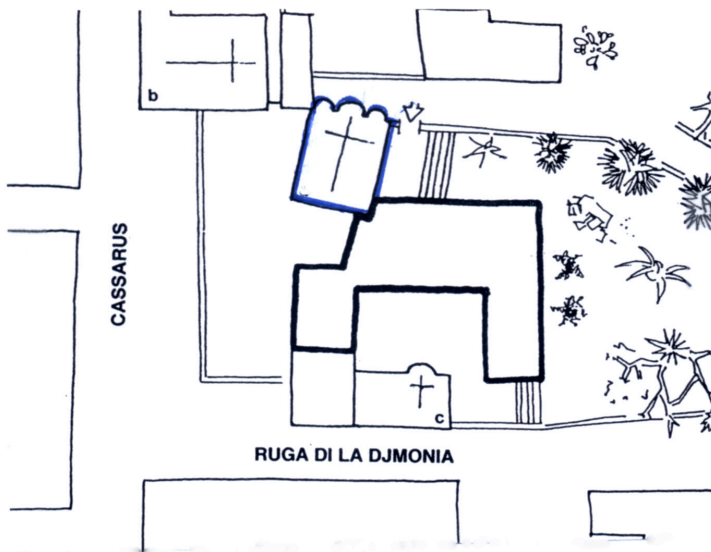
Chiesa San Salvatore, ipotesi planimetrica (XII sec)
